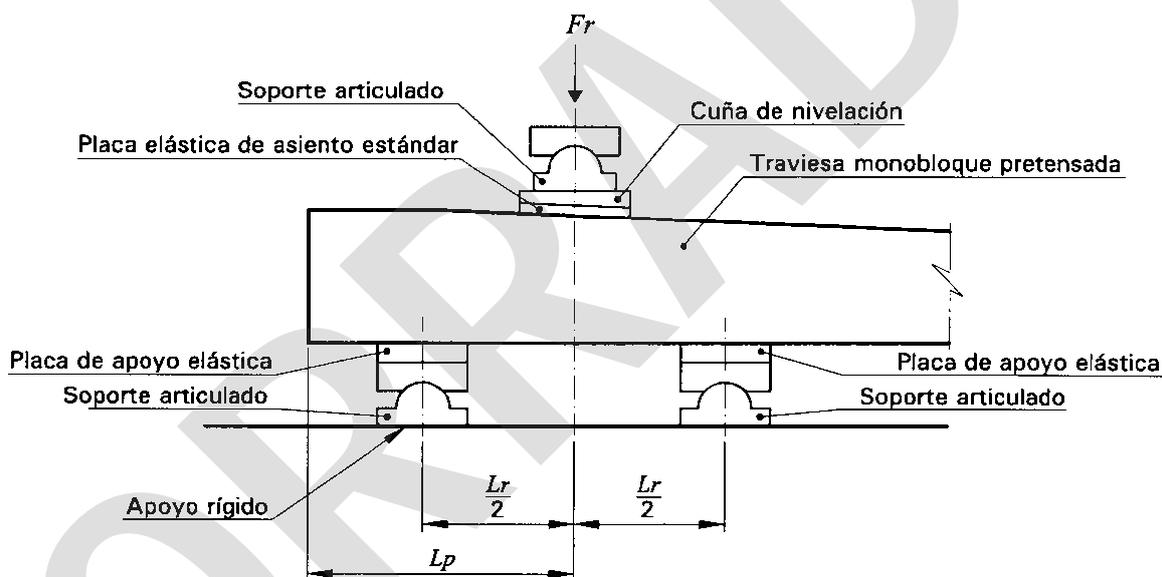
Montaje para ensayo a flexión positiva bajo carril
